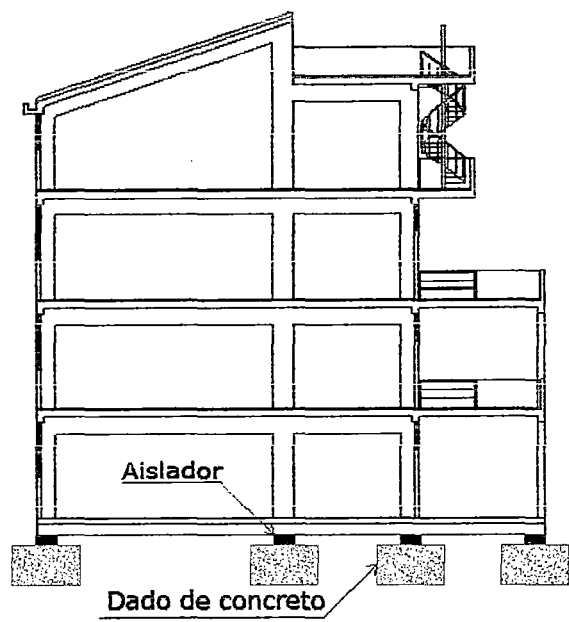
Vista en elevación de la ubicación de los aisladores sísmicos y cimentación de concreto.
